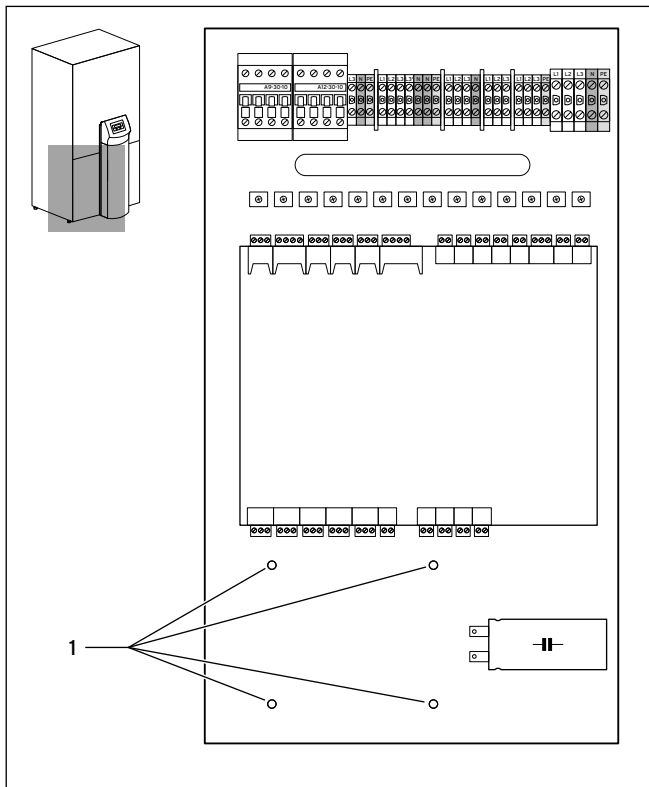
Montage Befestigungsstege geoTHERM VWL
